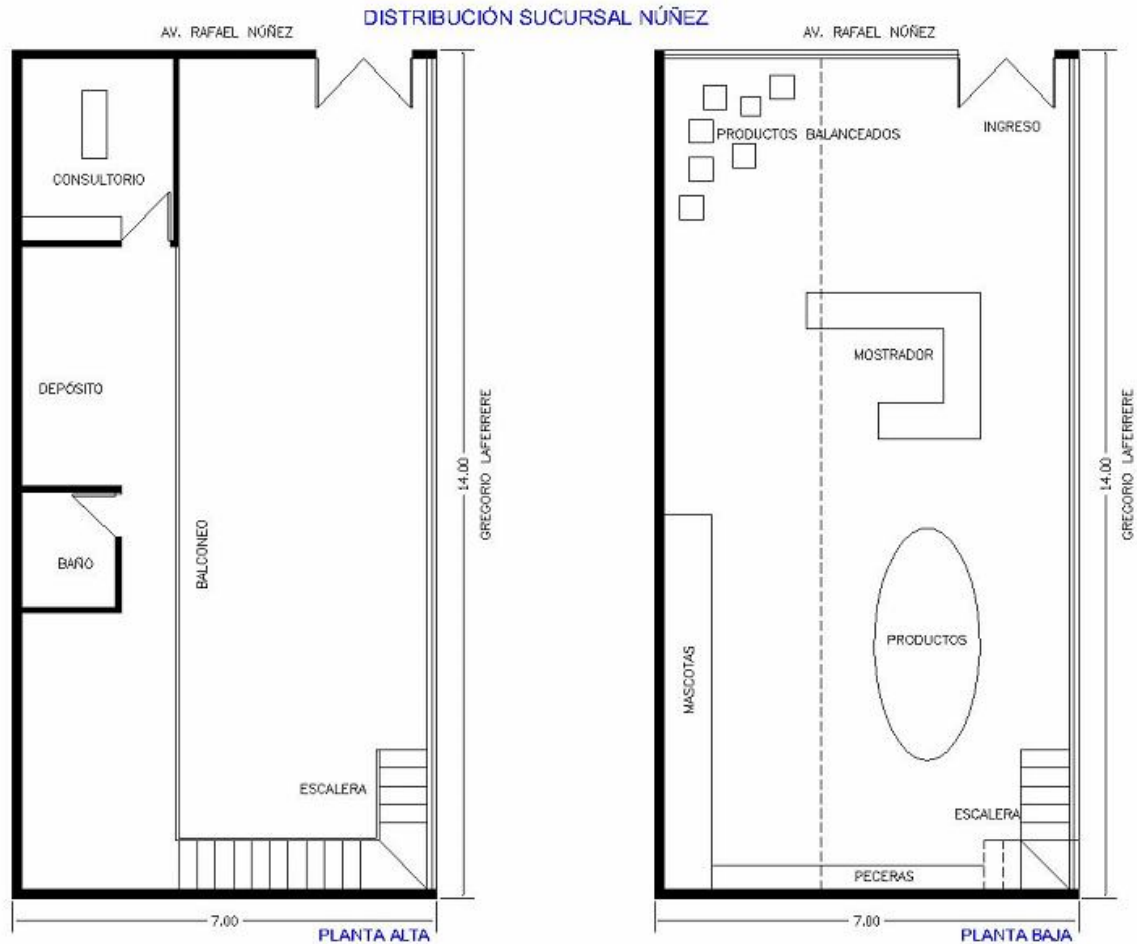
Croquis de la distribución de la sucursal Núñez, planta alta y planta baja²⁸.
